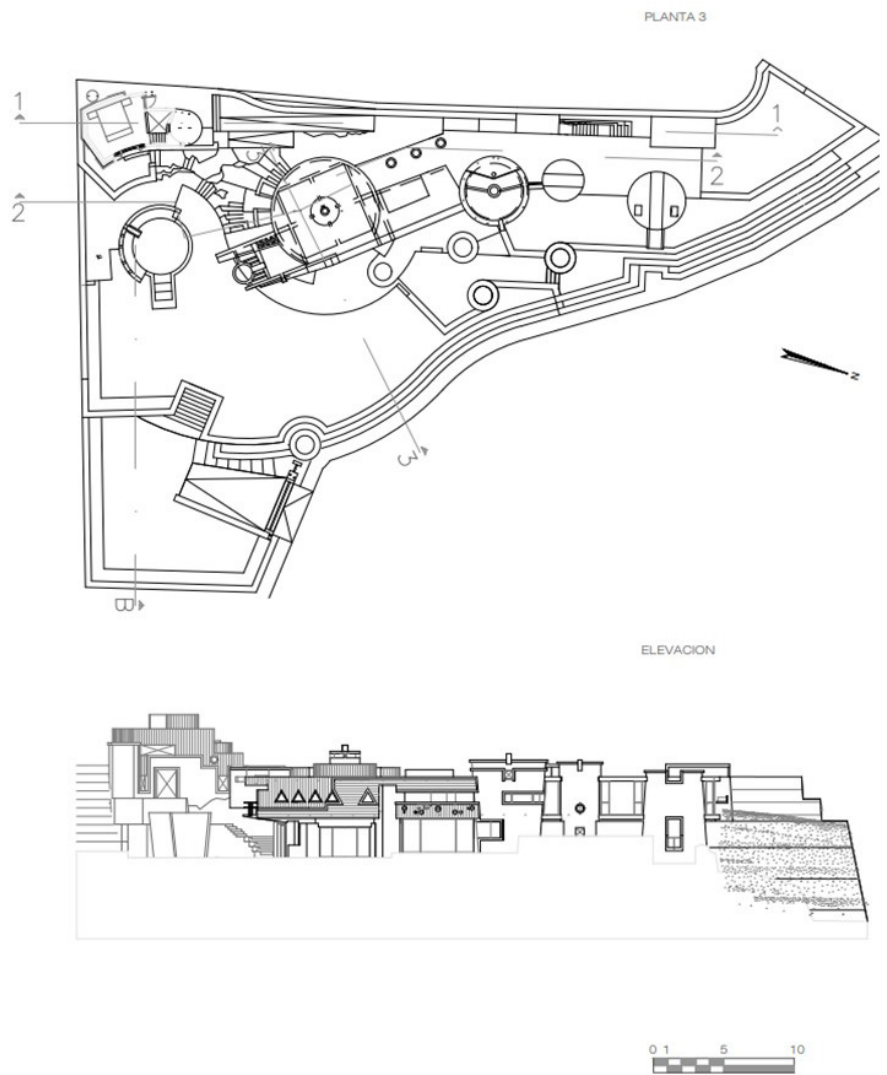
Plano alzado-corte de Casa Chullpa, arquitecto Luis Longhi (Fuente: Foto del autor)
